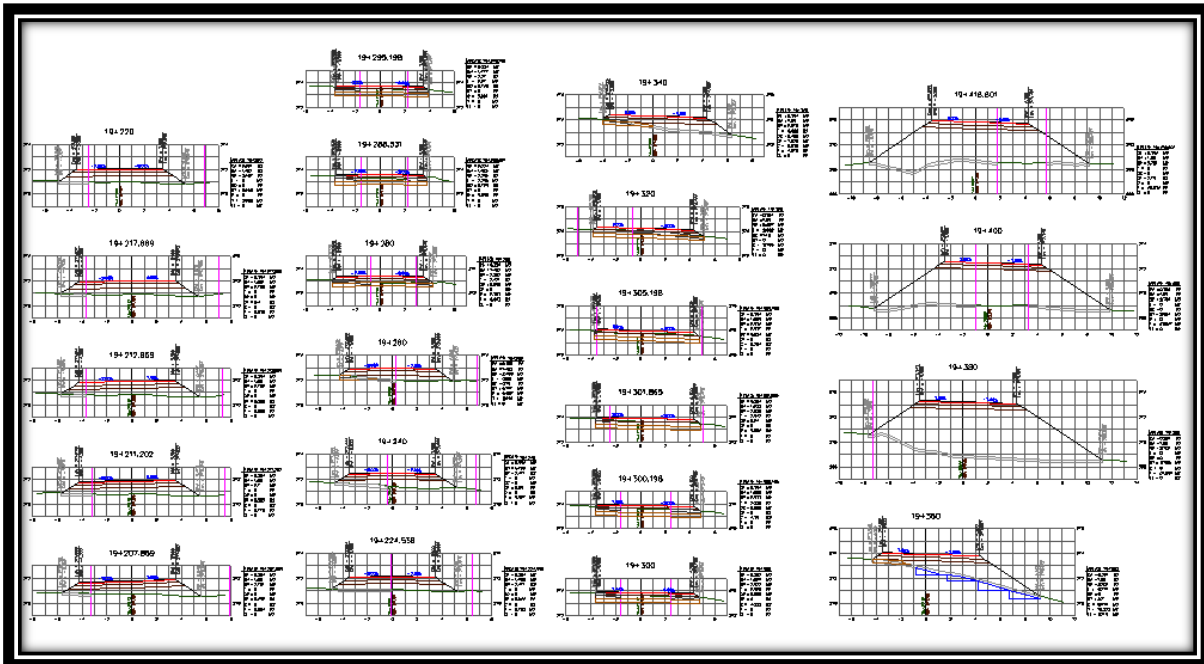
Secciones de construcción del km 19+207.869 al km 19+416.601.
